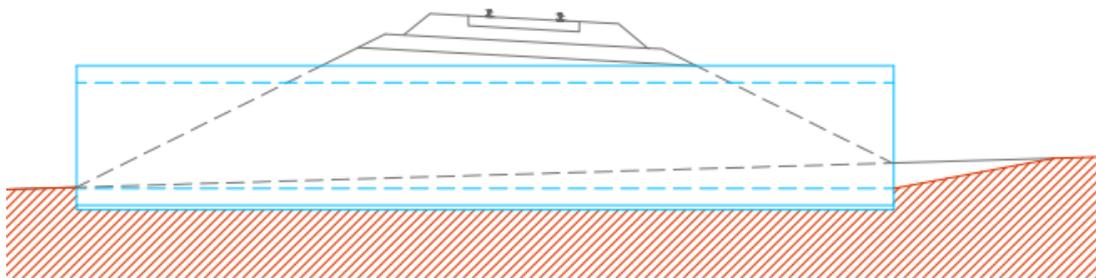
Vista sección A-A' obra drenaje P.K. 5+895
